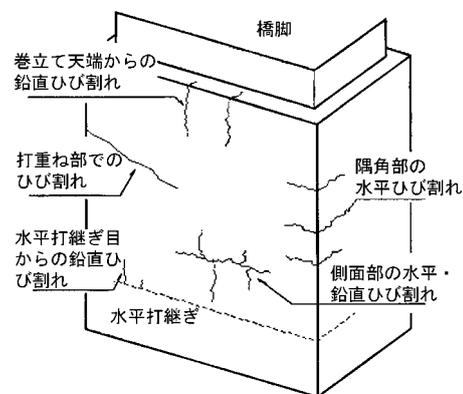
橋脚の巻立てコンクリートに発生するひび割れパターン³⁾
